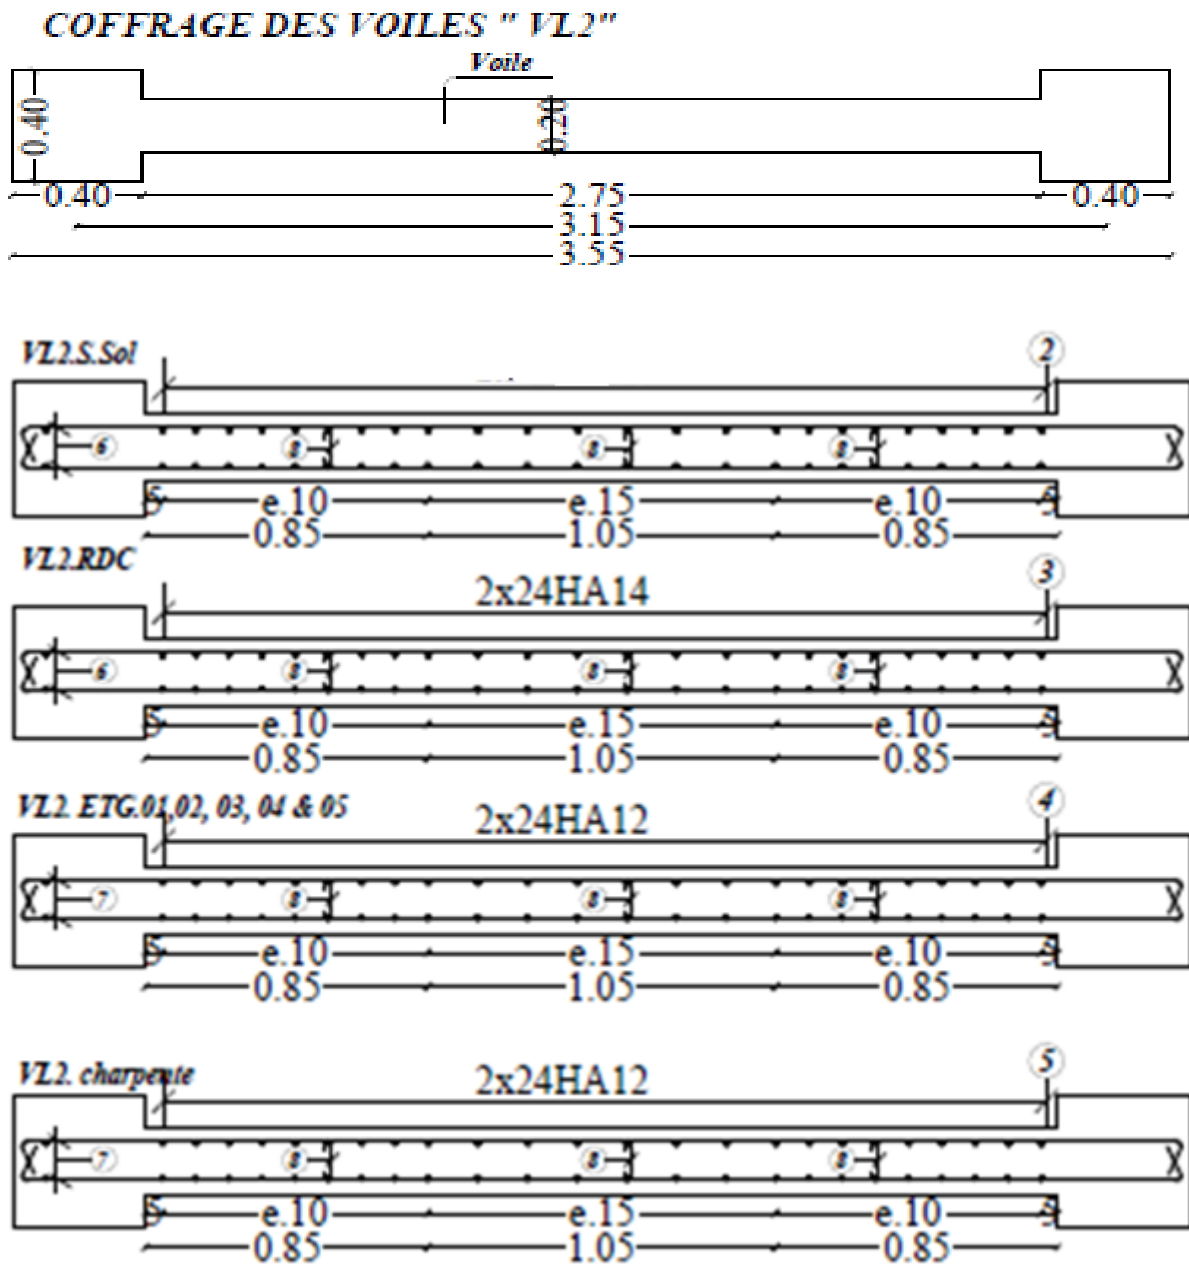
Schéma de coffrage et de ferrailage des voiles vl2
